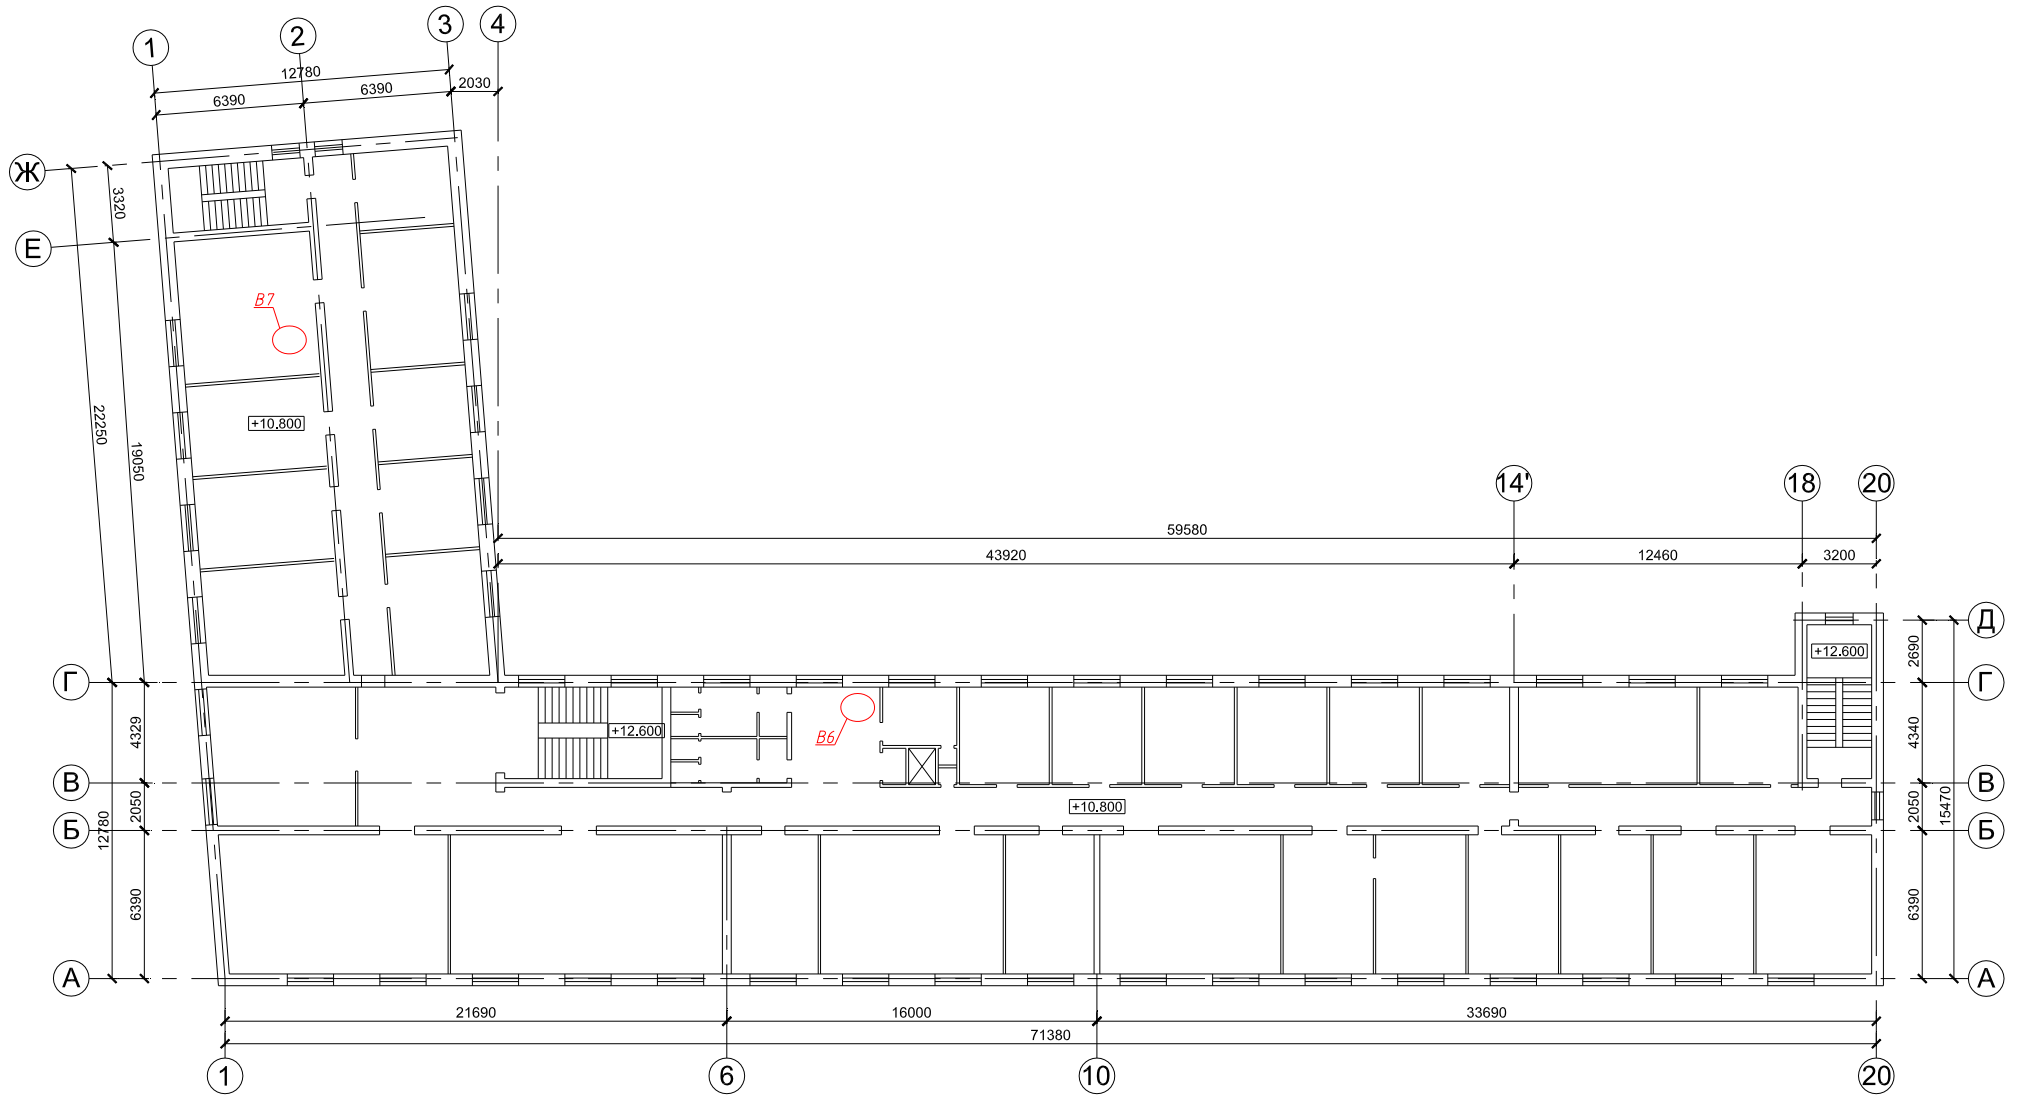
Схема расположения мест вскрытий конструкций пола четвертого этажа здания.
